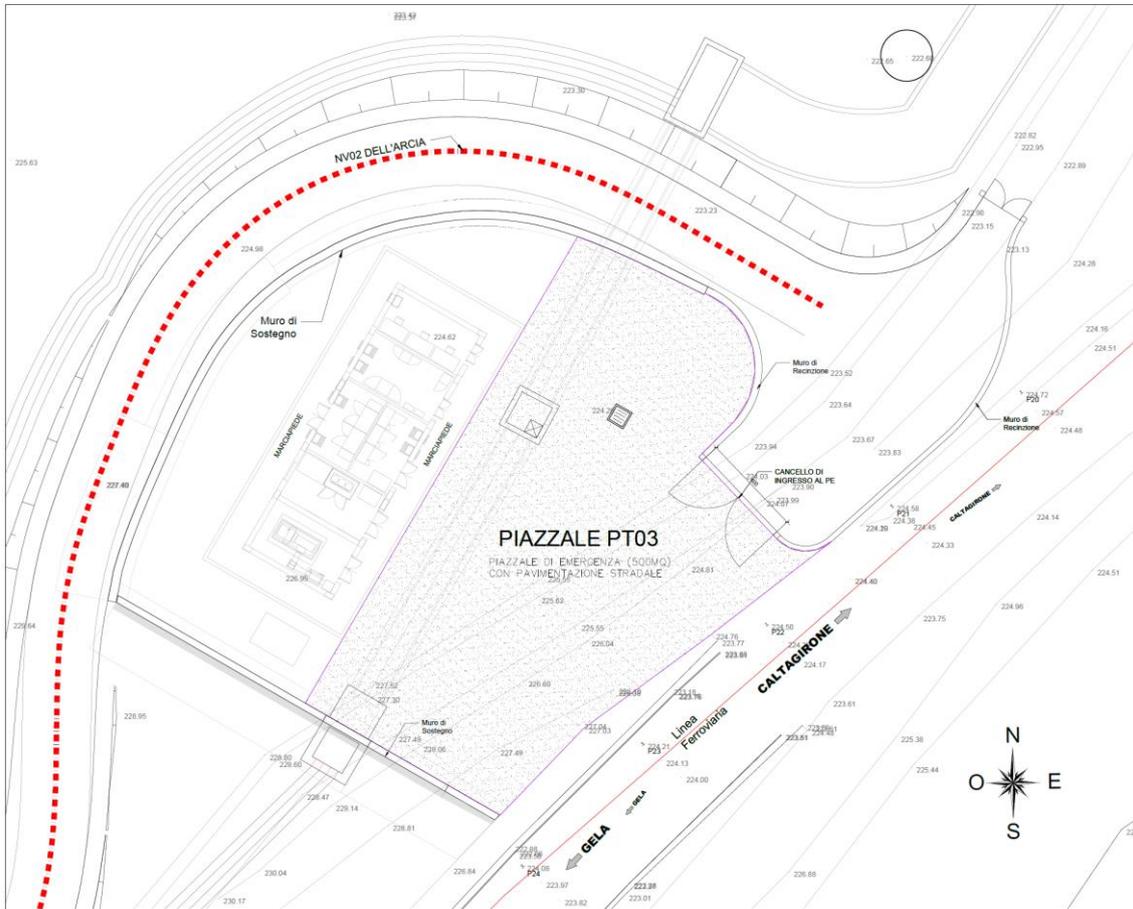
PT03 Planimetria piazzale di emergenza GA dell'Arcia imbocco nord
